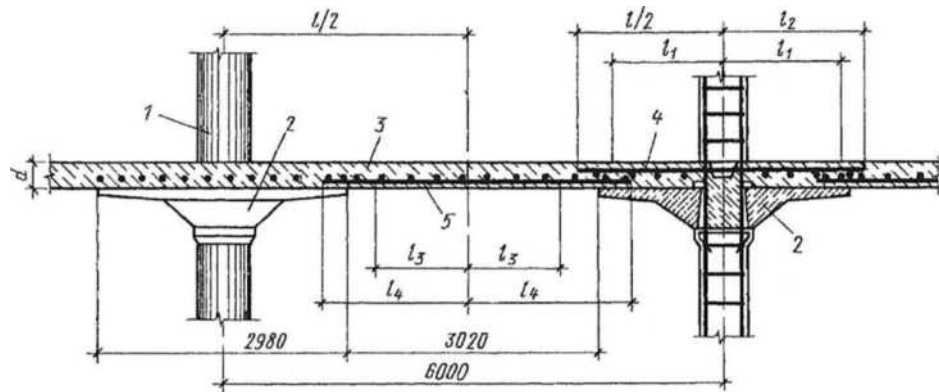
Безбалкове перекриття з монолітною плитою 1 - збірна колона, 2 - збірна капітель, 3 - монолітна залізобетонна плита, 4 - опорна арматура, 5 - пролітна арматура, б - по розрахунку.
